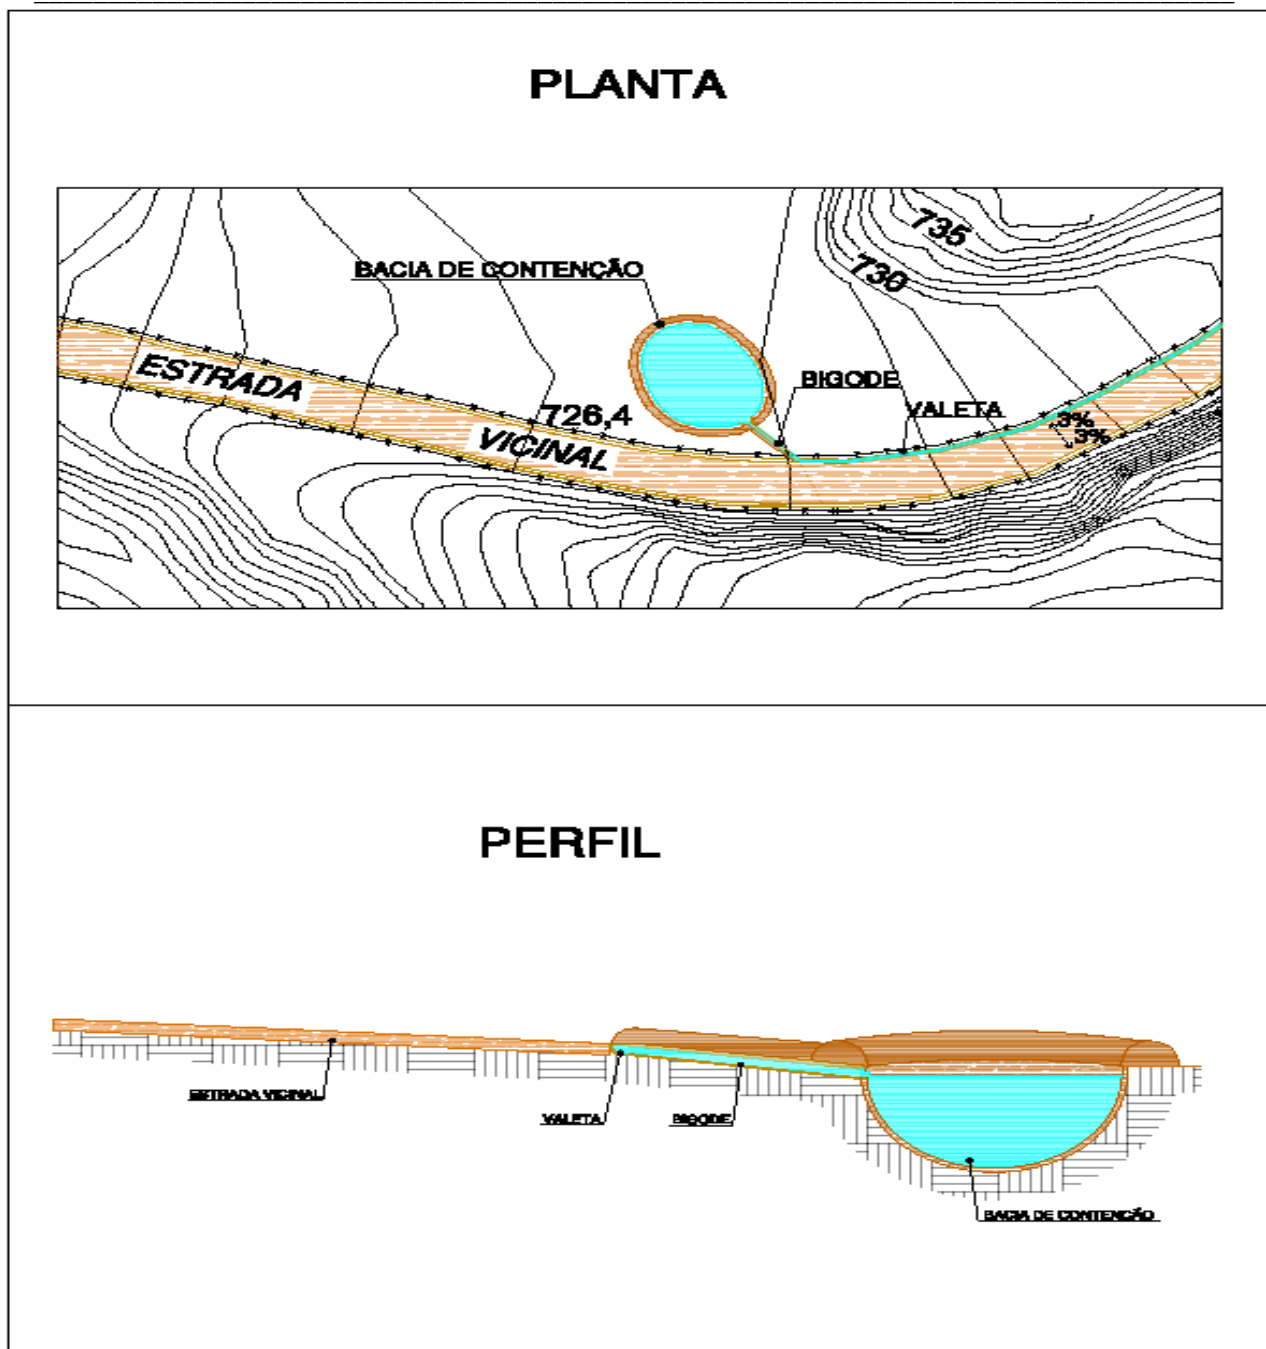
Planta e perfil de bacia de contenção de águas pluviais
